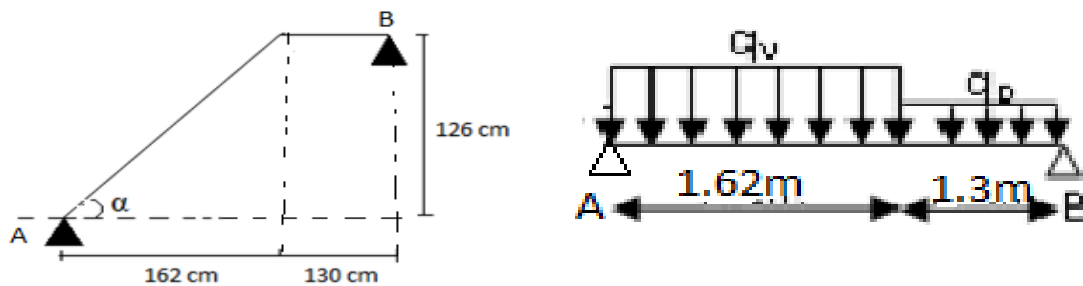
Coupe en élévation de l'escalier du type 01 Figure III.28. Schéma statique de l'escalier type 1
